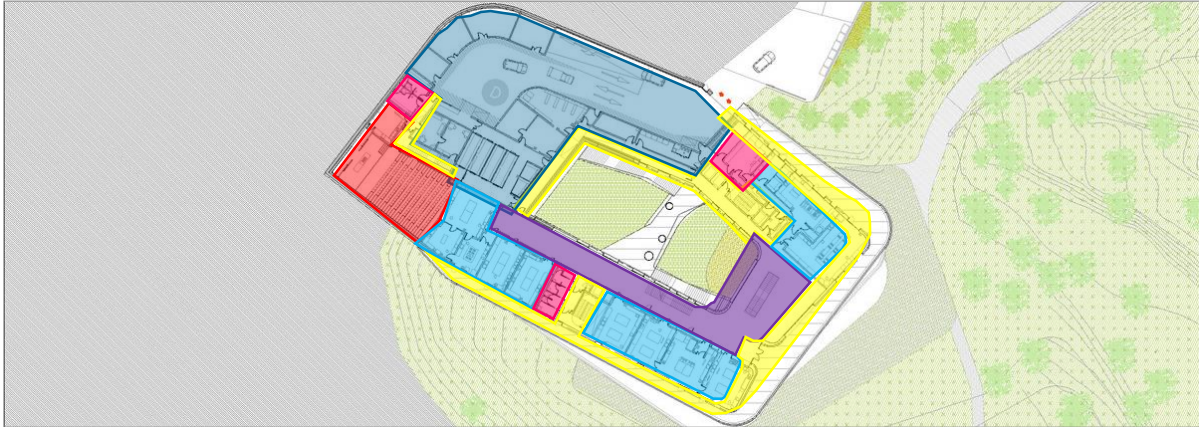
Zonificación Planta 2 (ArchDaily Perú, 2011) Elaboración Propia.
